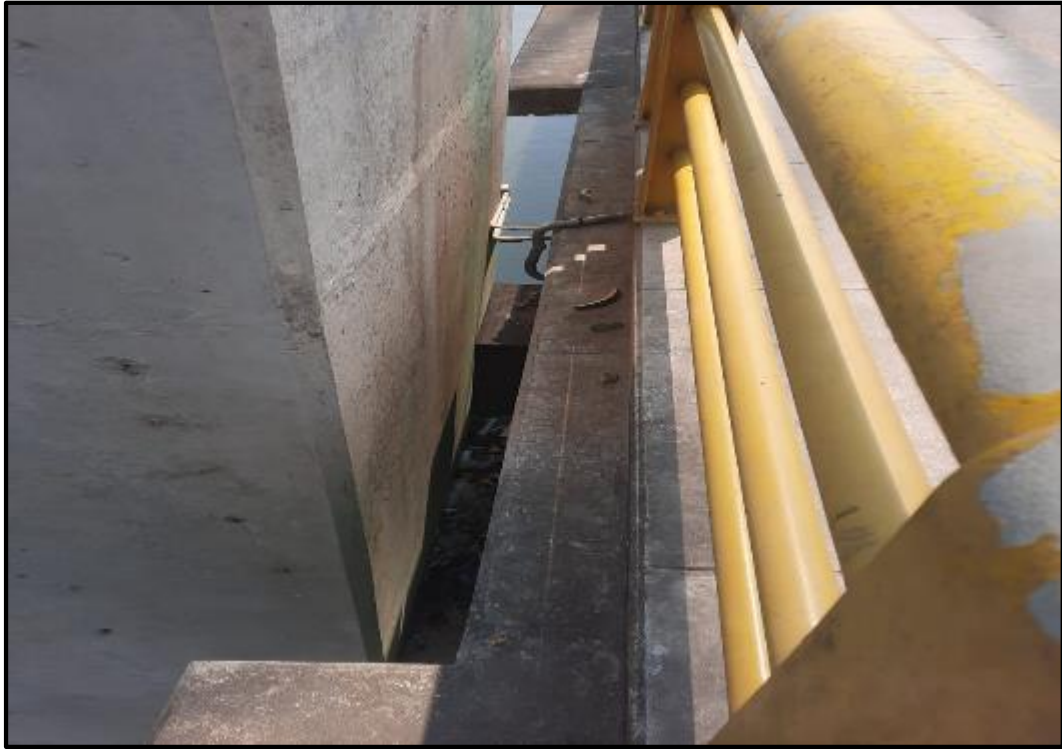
Se aprecia basura en la conexión del Pilón con el tablero del puente margen izquierda.
